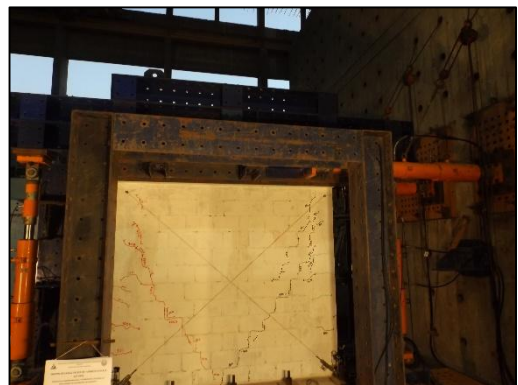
Mas grietas en la diagonal del muro para una distorsión 1/800.
